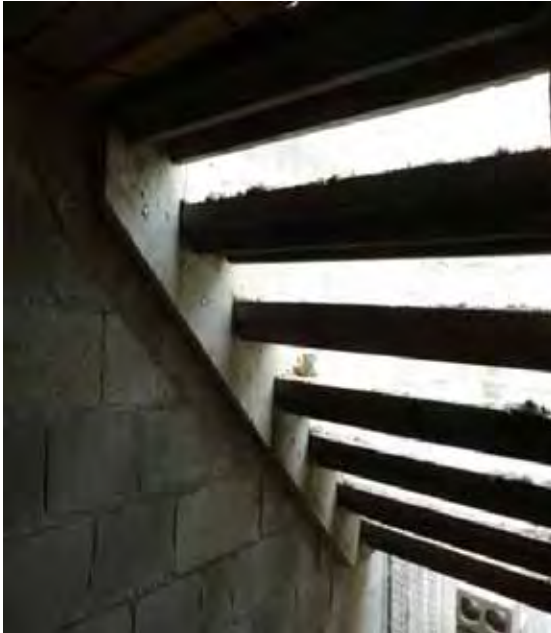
Laje pré-moldada (maciça) / vigas de concreto
